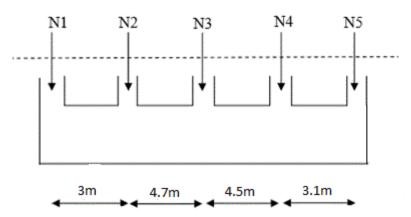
schéma statique d'une semelle filante suivant le sens y-y (file E).
